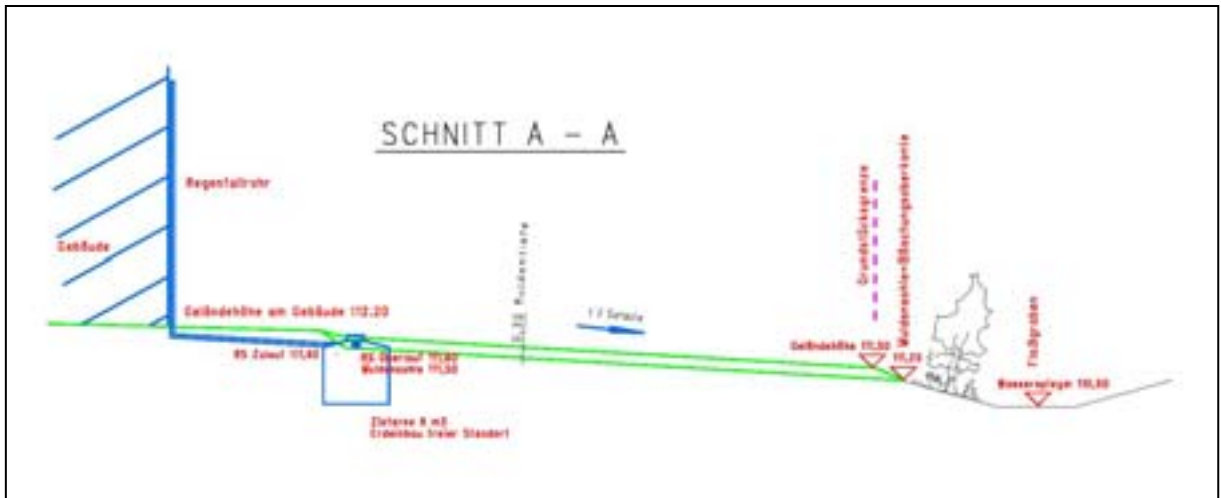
geplante Ableitung des Niederschlagswassers, Geländeschnitt A-A
